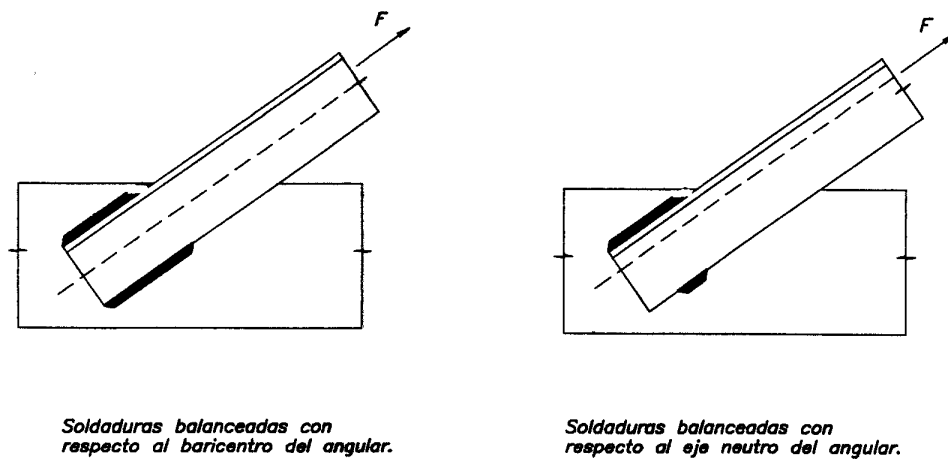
SOLDADURAS BALANCEADAS
